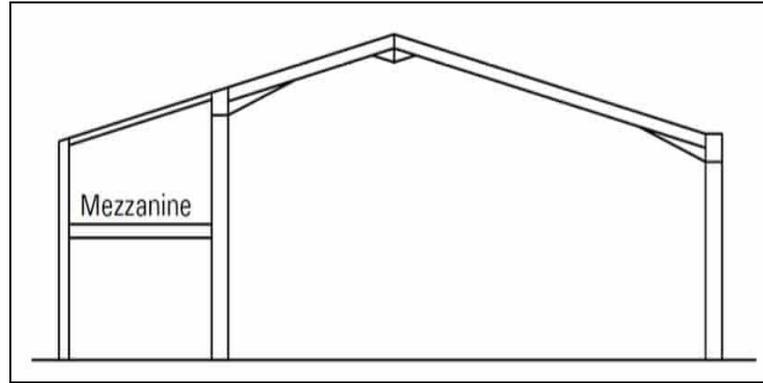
4 Portal Frame Dengan Lantai Mezzanine
